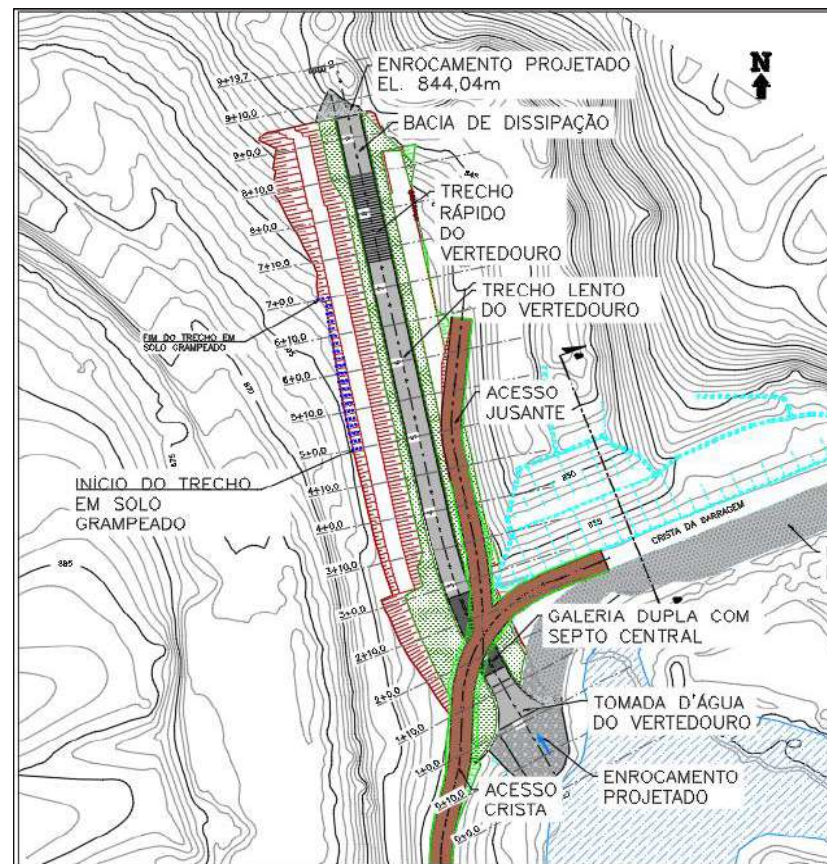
Planta com a localização das seções transversais (Estaca 0+10,00 até 9+0,00).
